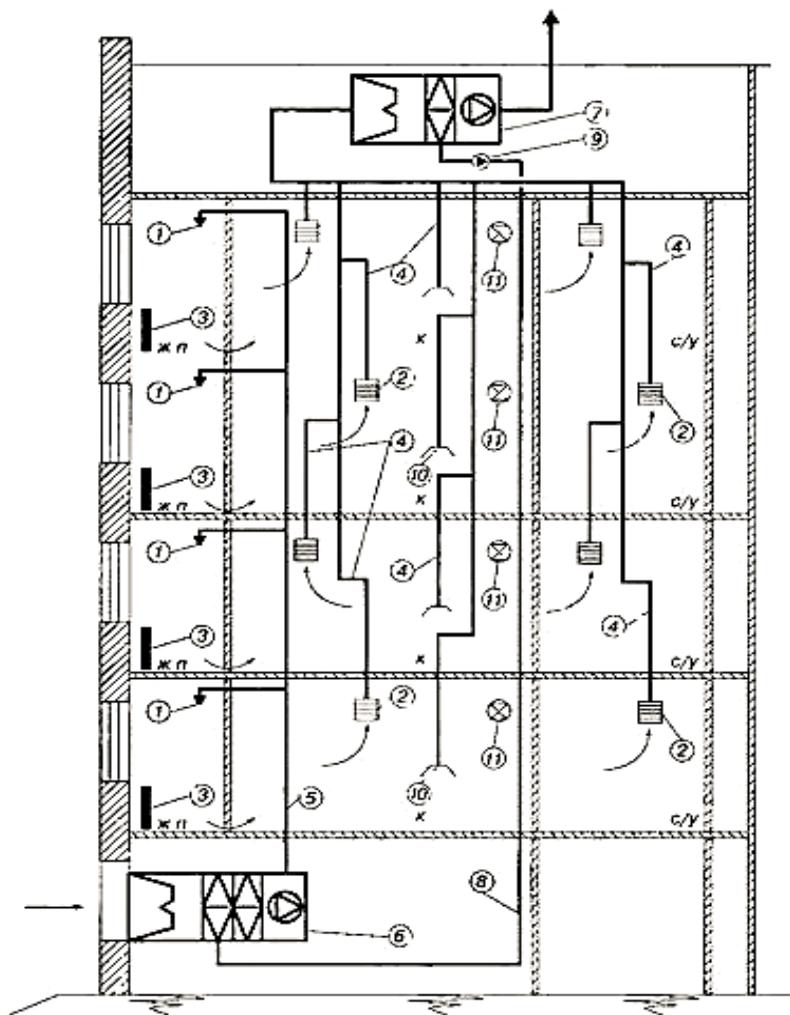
Схема системы механической приточно-вытяжной вентиляции (центральная) с утилизацией тепла вытяжного воздуха (утилизация с промежуточным теплоносителем):
